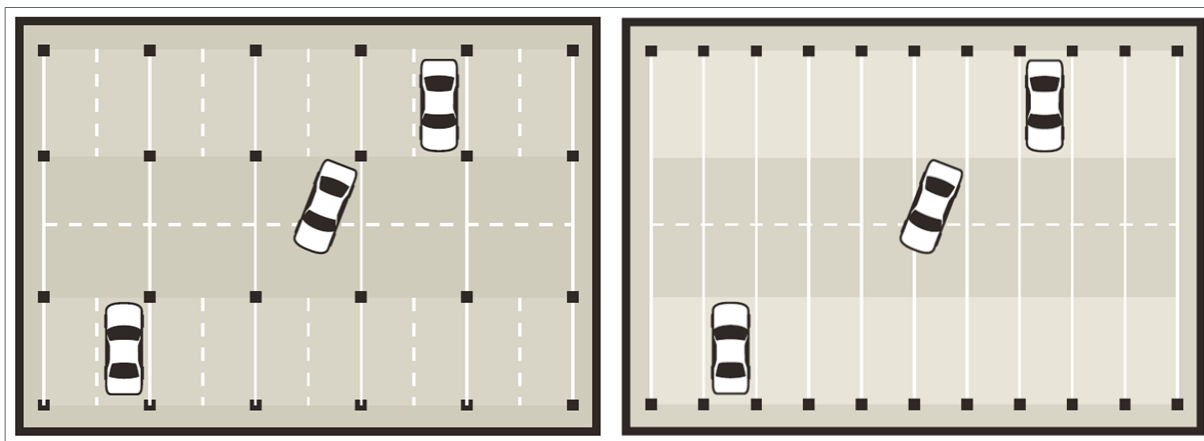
Принципові планувально-композиційні схеми багатопверхових автостоянок: 1 – із внутрішніми колонами, 2 – ефективні відкритого планування
